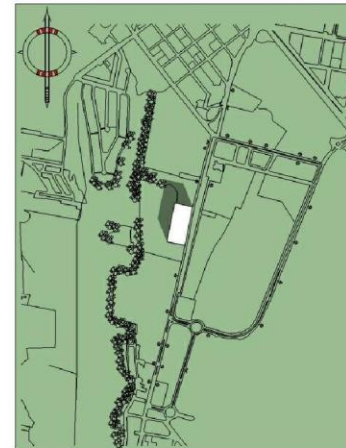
Soleamiento 04 de Marzo a las 12 p.m.
